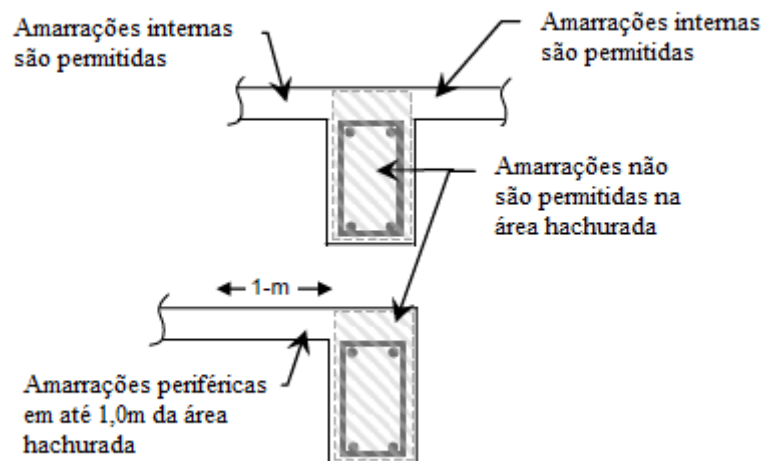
Restrições para localização das amarrações internas e periféricas.
